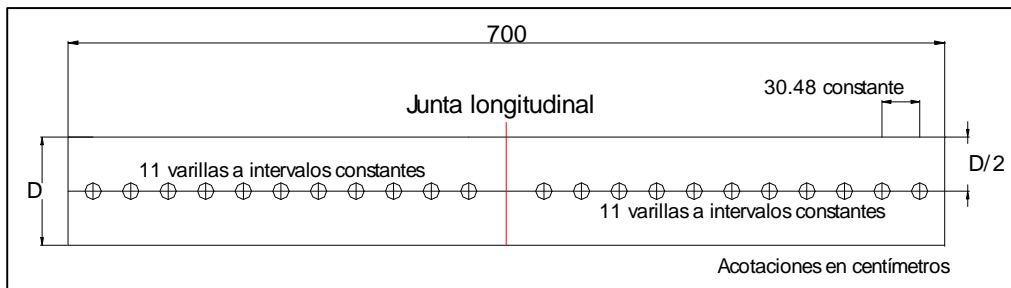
Disposición de pasajuntas con separación constante en una junta transversal de contracción.
